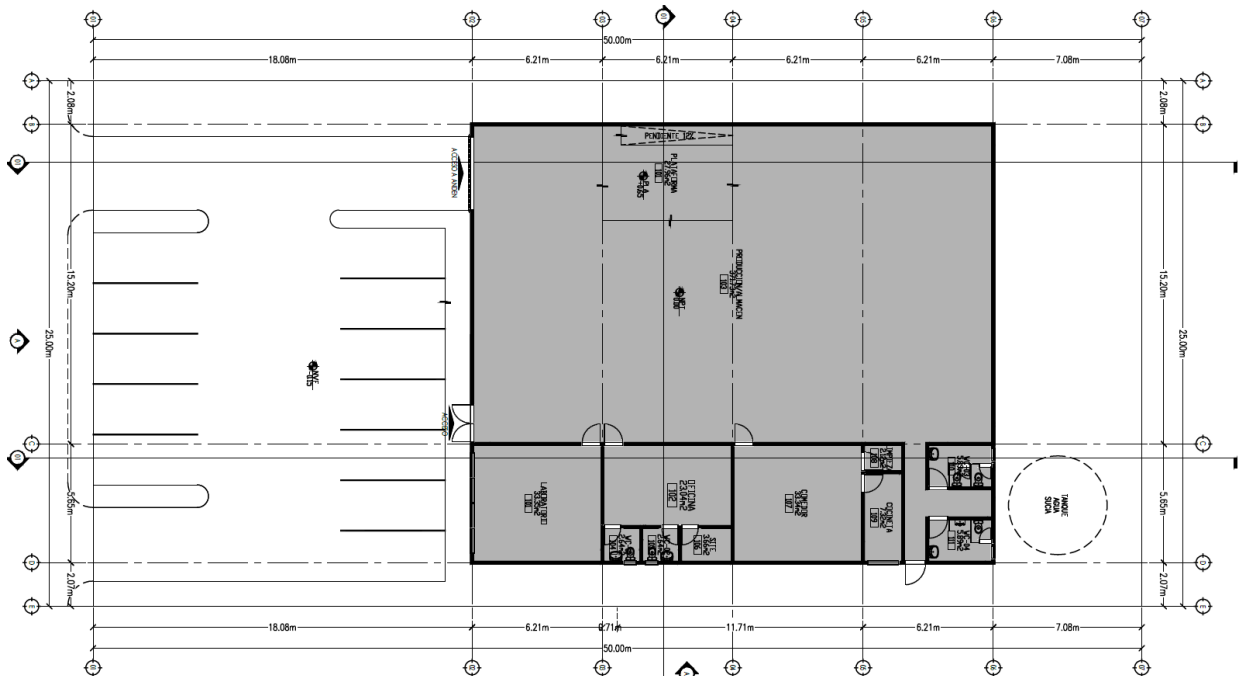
Plano Arquitectónico de Anteproyecto. *Elaboración Propia TDU. Ver Anexo 14.
